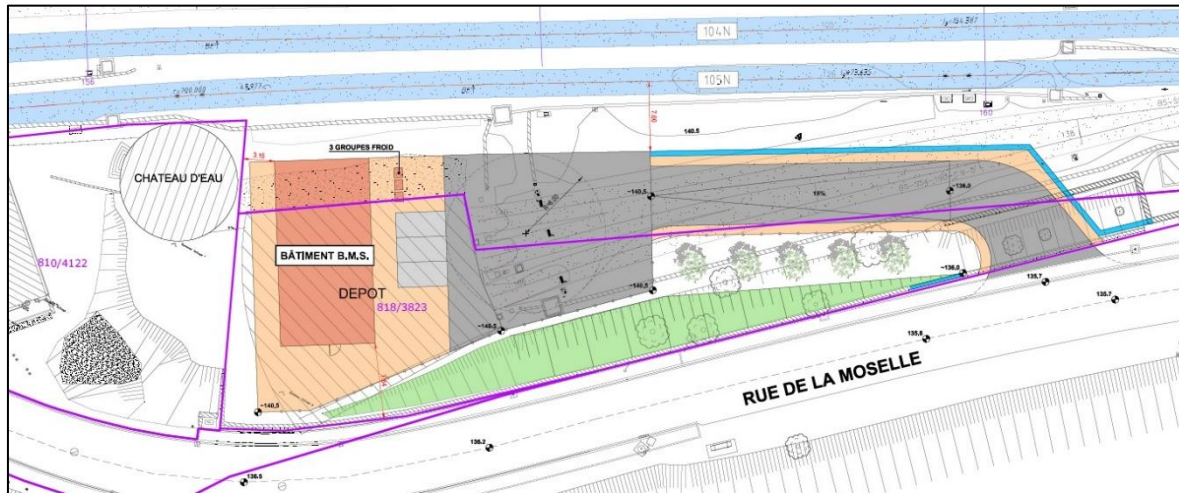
Geplante Zufahrt zum bestehenden Depot am Wasserturm in Wasserbillig („Avant-projet détaillé“ © TR Engineering, Planentwurf vom 13. Dezember 2016).
